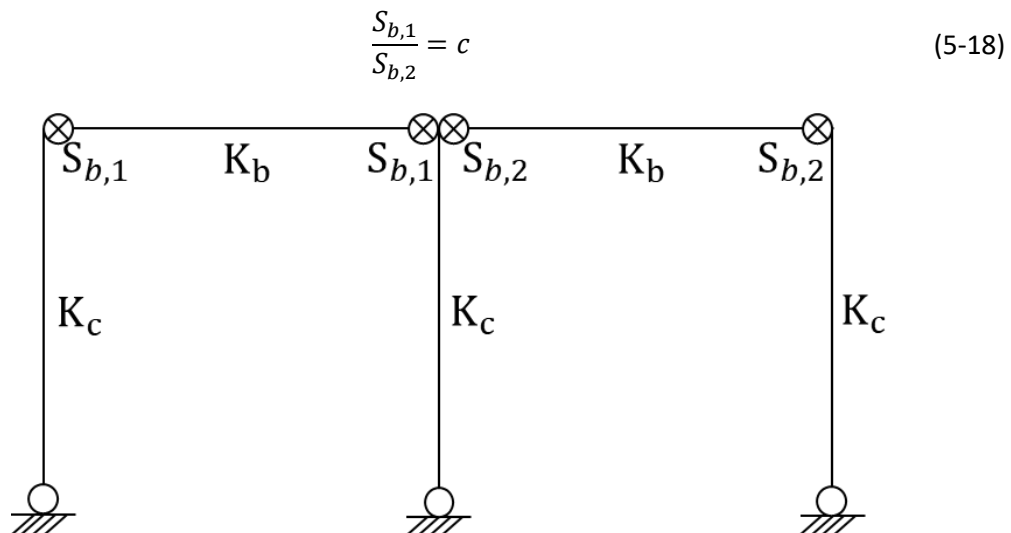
Structure à deux travées, rigidité unique pour les deux assemblages d'une même poutre mais différente d'une poutre à l'autre
